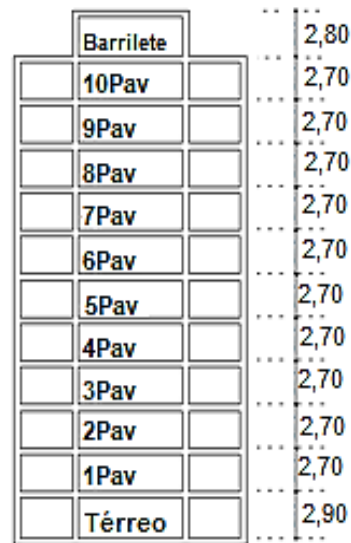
Corte esquemático da torre de alvenaria (medidas em metros).
